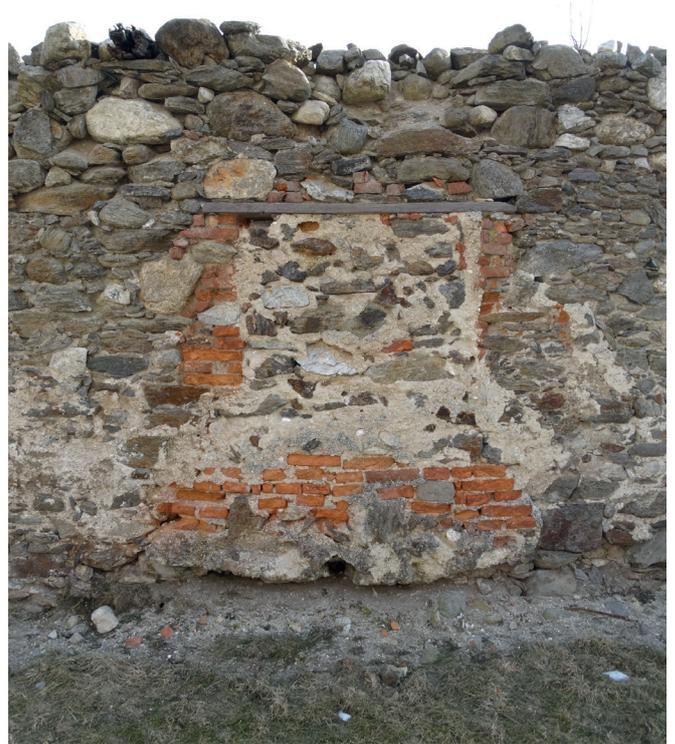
Vermauerter Durchgang zum Garten; stark beschädigte Mauerkonstruktion
